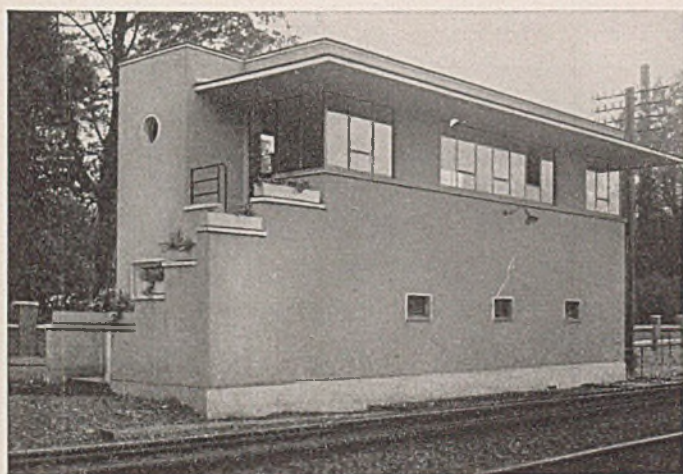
Untergeschoß Ziegelbau, oben Beton. Flächen grüner Edelputz.
